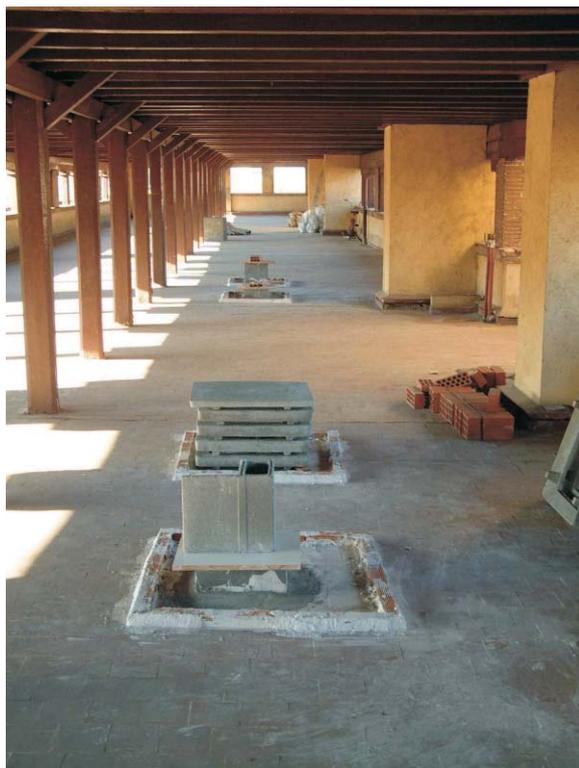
º - Chimeneas de nueva construcción en zonas comunes de tendedero en cubierta.
